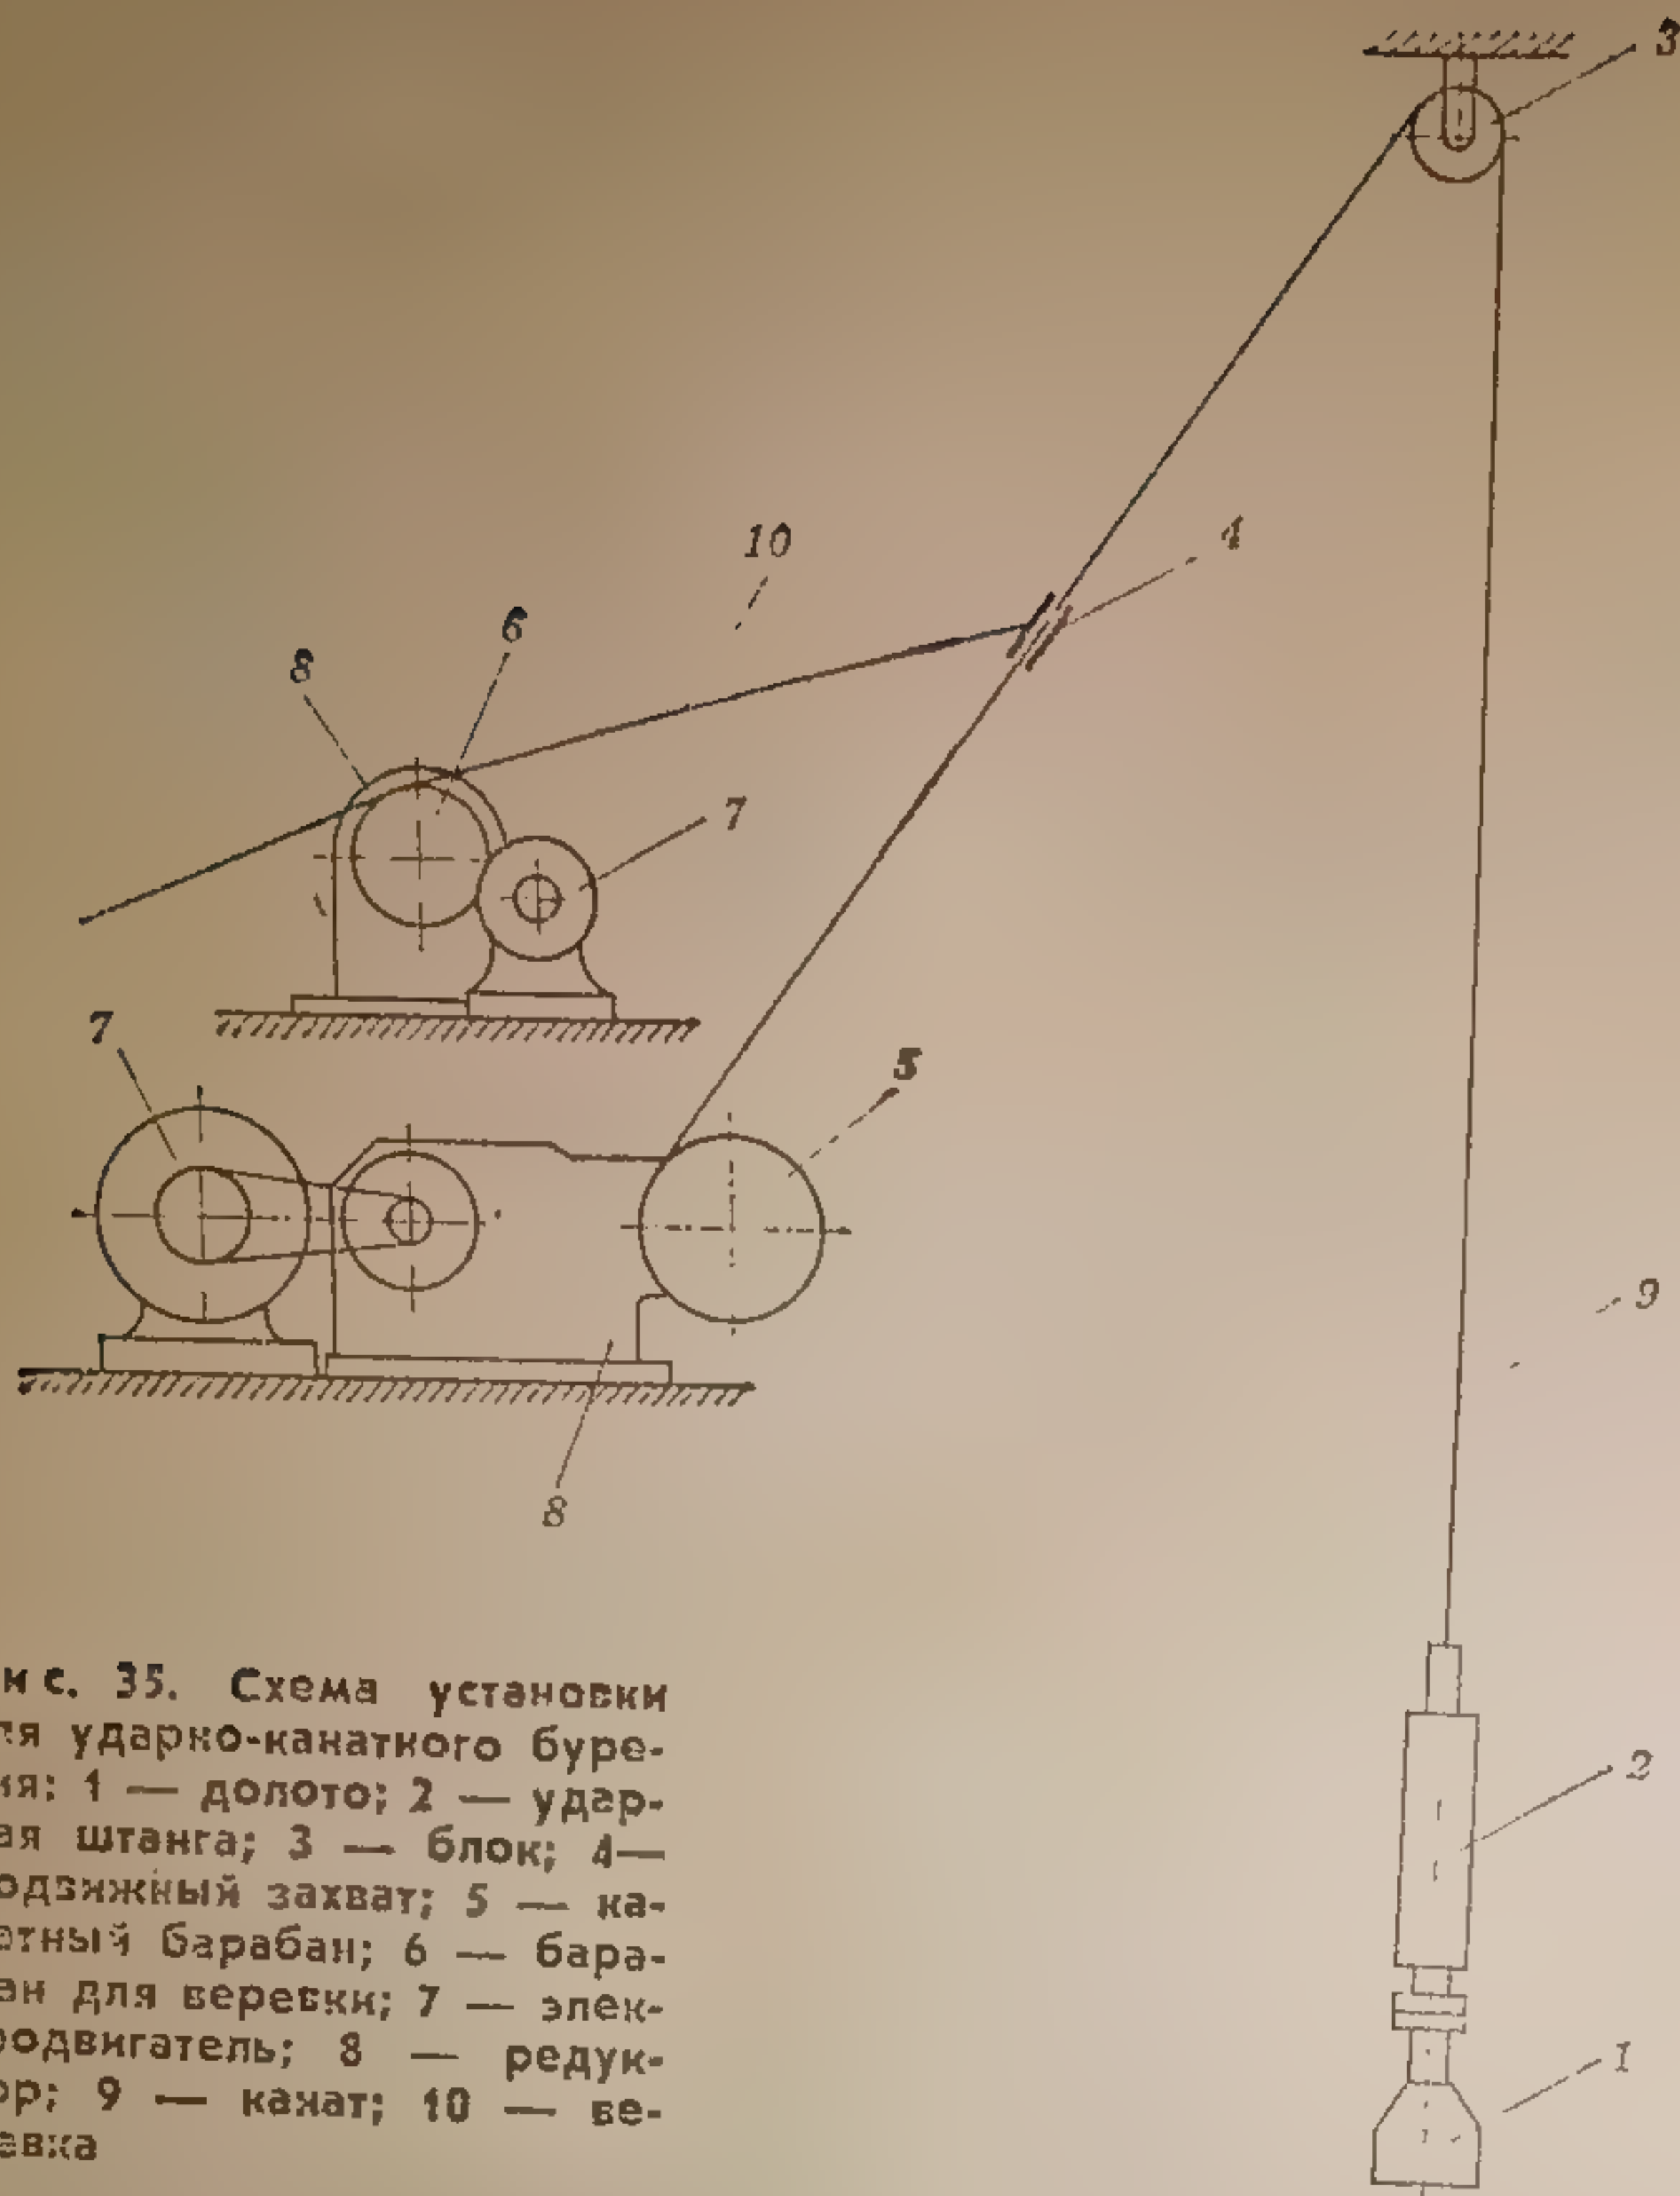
Схема установки для ударно-канатного бурения: 1 — долото; 2 — ударная штанга; 3 — блок; 4 — подвижный захват; 5 — канатный барабан; 6 — барабан для веревки; 7 — электродвигатель; 8 — редуктор; 9 — канат; 10 — веревка
